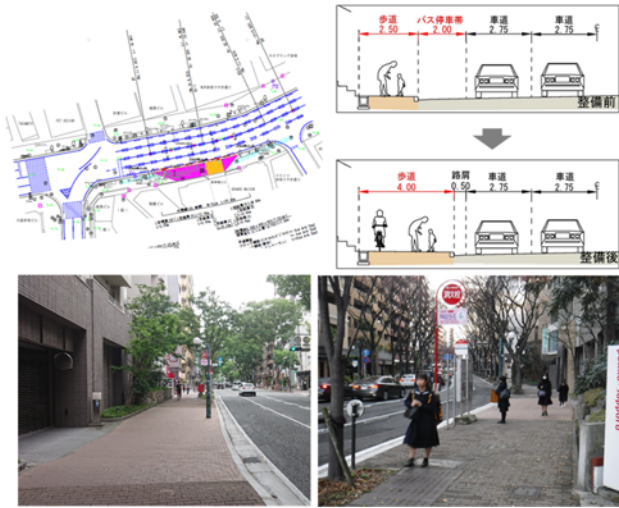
バスカット閉塞の概要 (左：平面図, 右：横断面)
